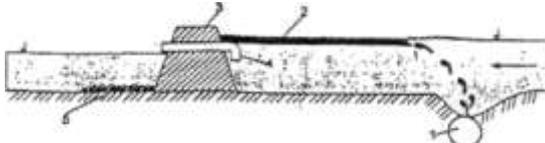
Перекрытие водостока плотиной, оборудованной гидрозатвором:
